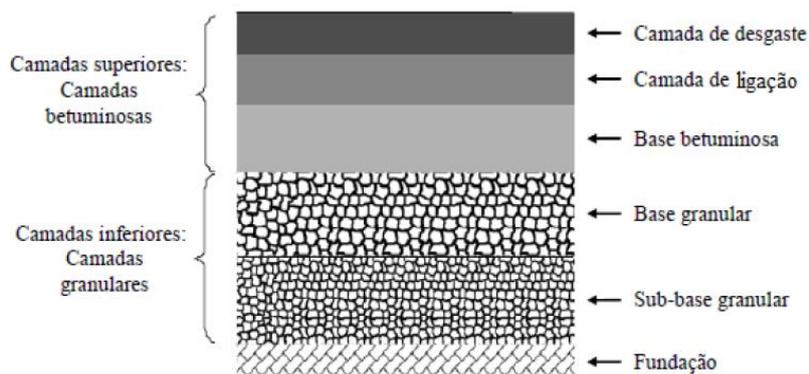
Diagrama da constituição de um pavimento flexível mais em pormenor
